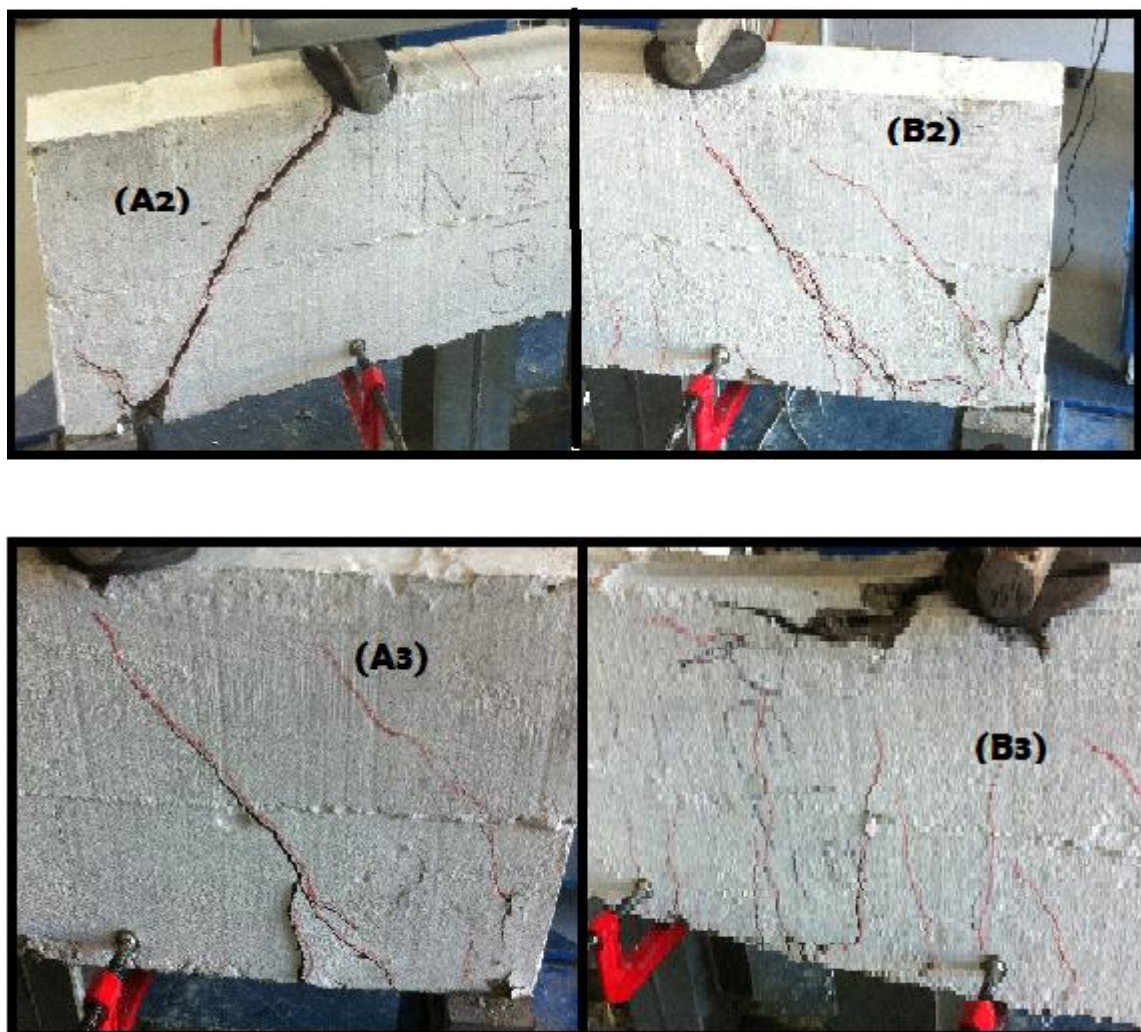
Vigas fissuradas após ruptura espaçamento a três terços.
